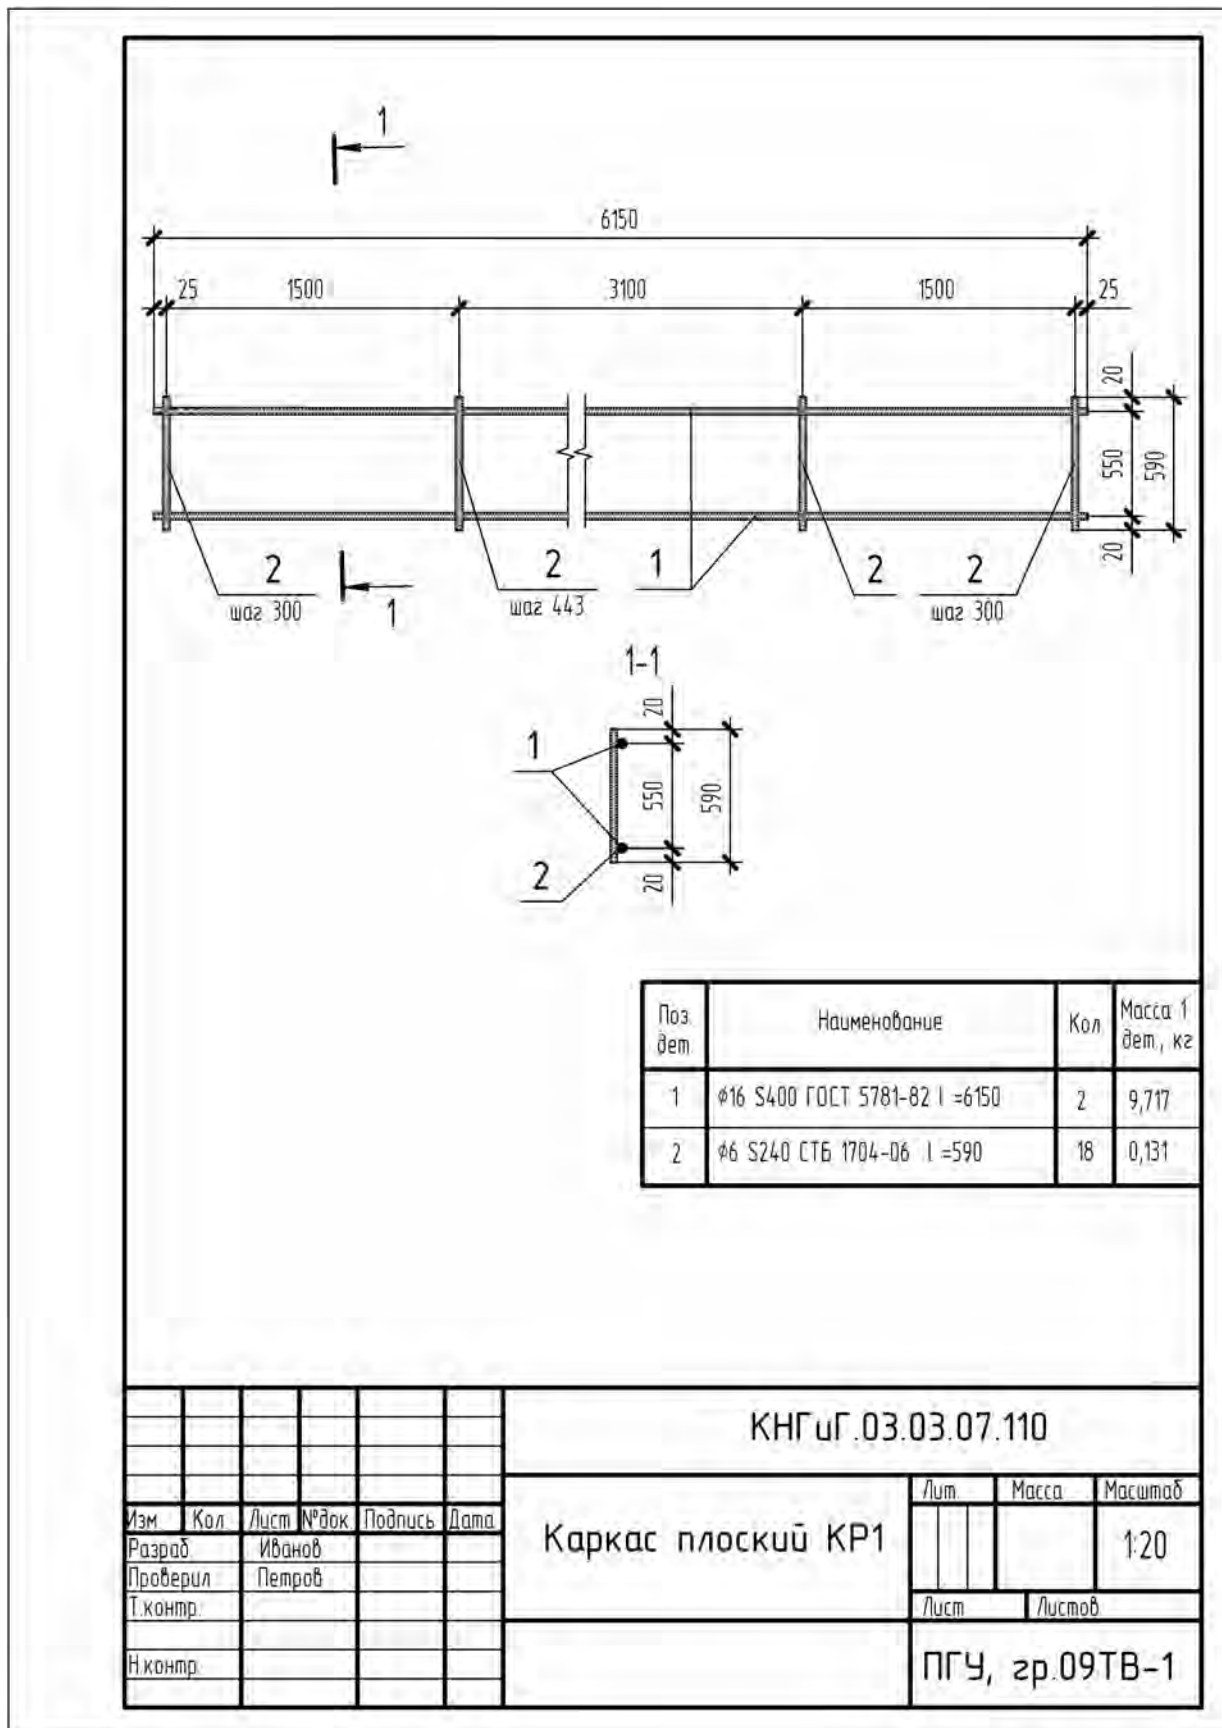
Рабочий чертеж каркаса плоского КР1 для балки Б5
